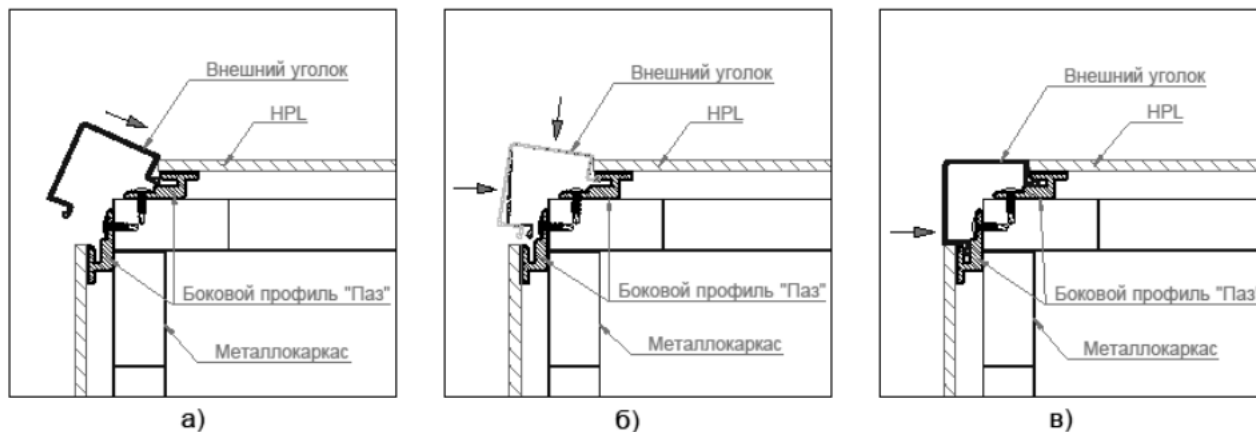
Схема установки панелей для монтажа внешнего уголка
